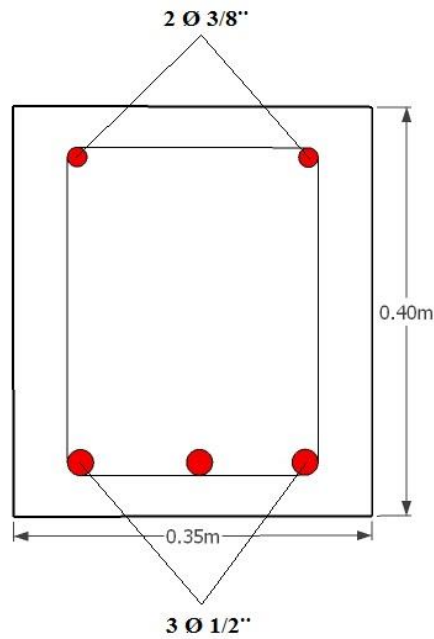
Sección de la Viga Longitudinal del Descanso.
